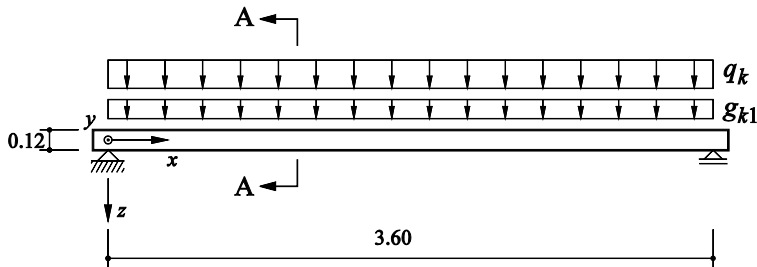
Ansicht Platte mit Lagerung und Belastung
